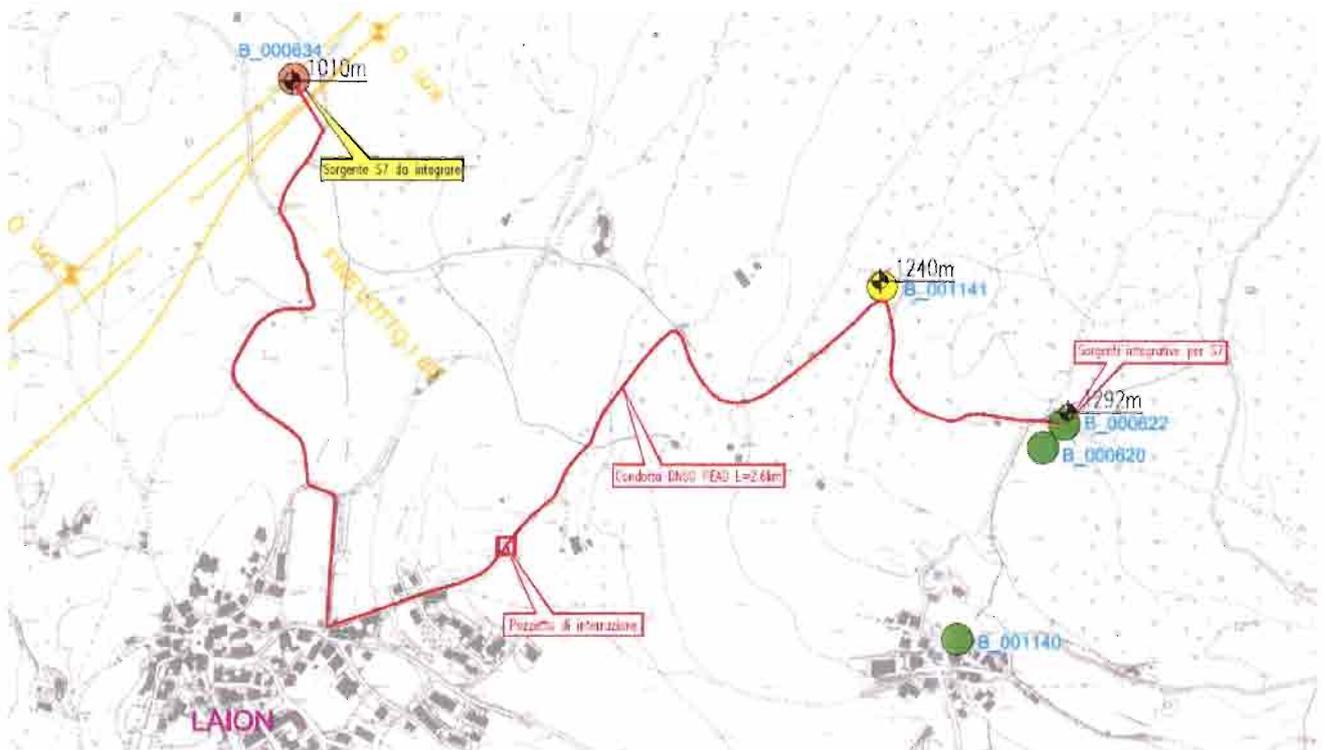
Stralcio planimetrico della soluzione progettuale selezionata.
